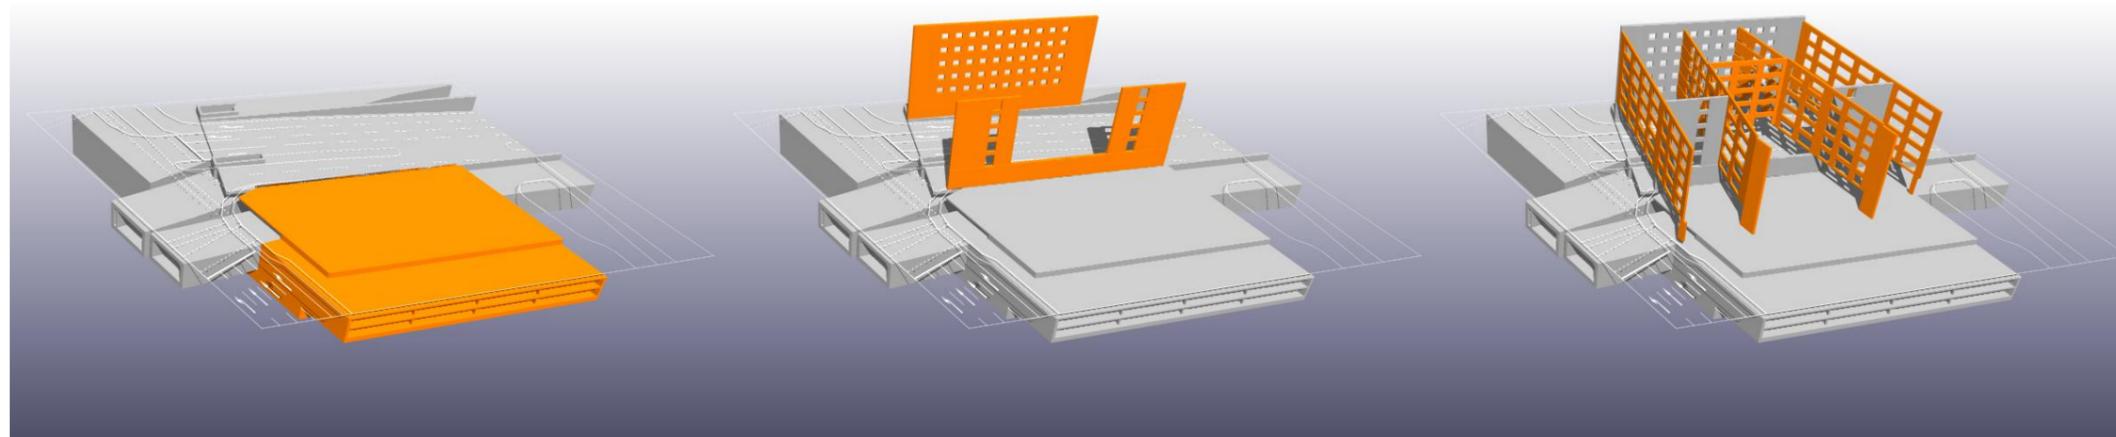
Vorgeschlagene Lösung: gemeinsame Flächengründung von Tiefgarage Lehrter Bahnhof, Straßentunnel und Gebäude MK2 auf einer durchgehenden Sohlplatte Abb. II.10 Lastverteilende Wände auf den lastabtragenden Scheiben W1 und W2 Abb. II.11 Die den Rampenbereich überspannenden wandartigen Träger W3-6
